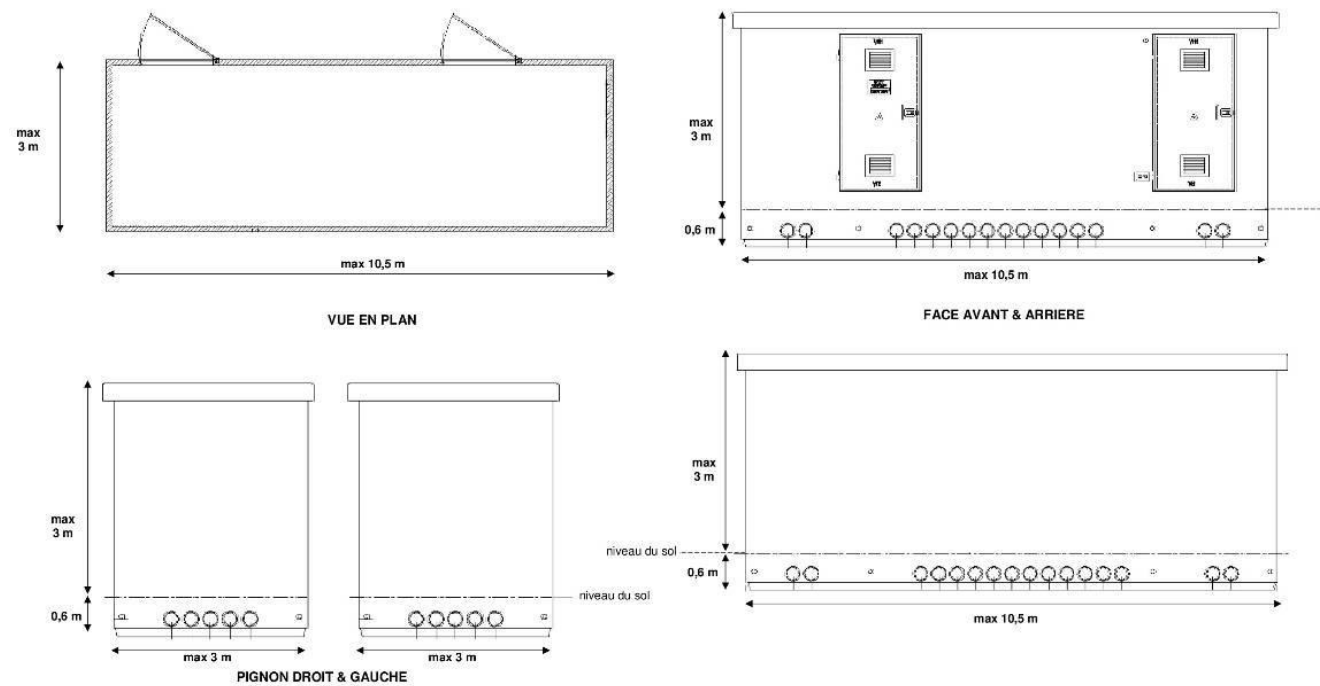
Plan type d'un bâtiment composant une structure de livraison
